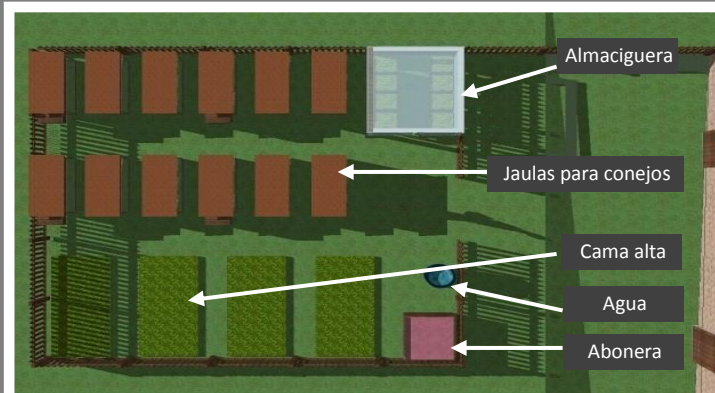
Planta de área de confinamiento para la cunicultura familiar.
